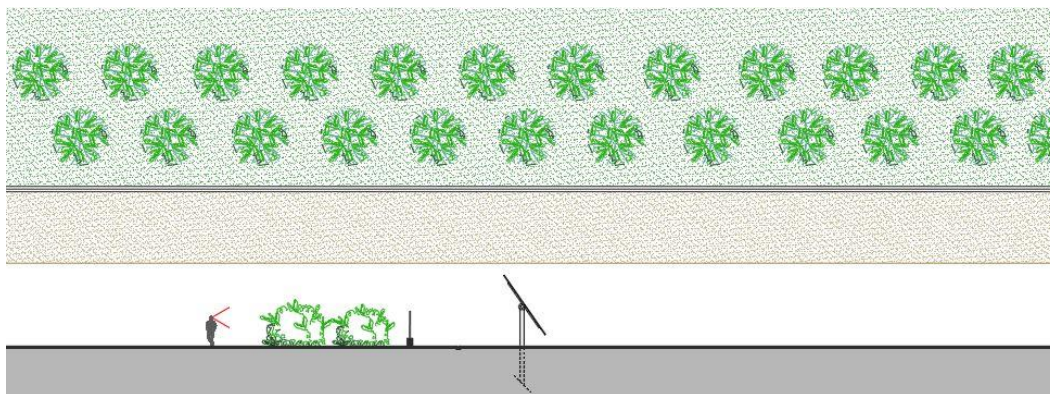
Pianta e sezione della fascia perimetrale da piantumare per ridurre l'impatto visivo
